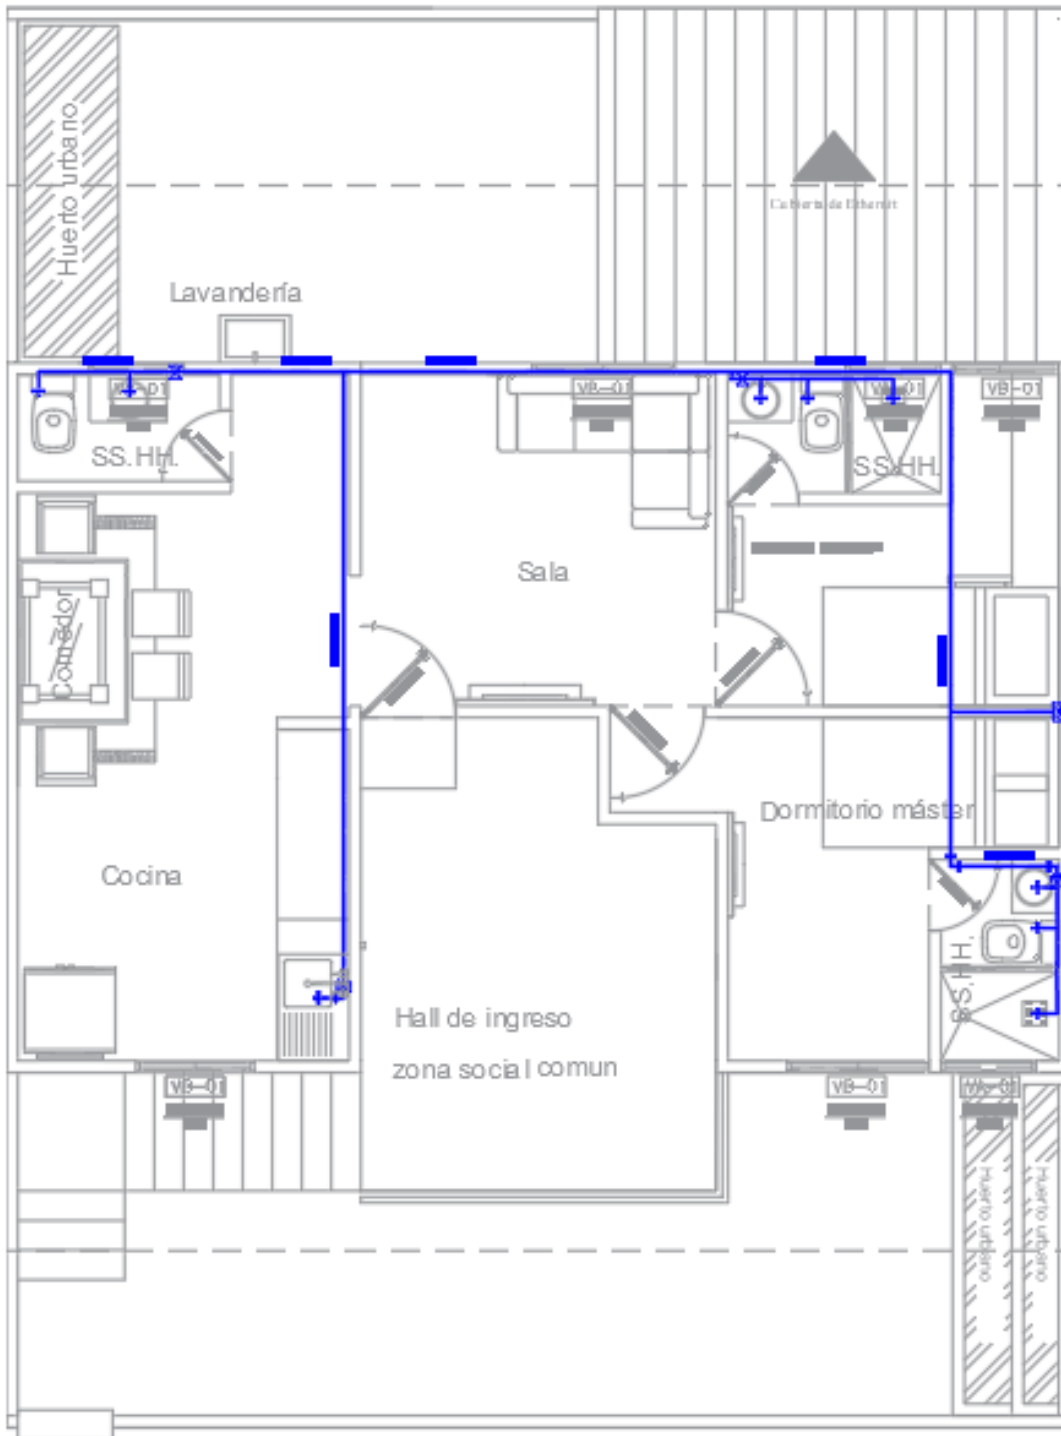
Plano de ingeniería - agua potable – planta baja
